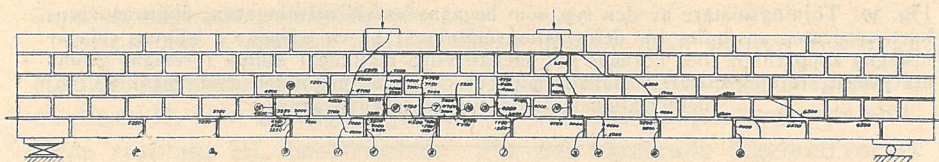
Sprickbildningsschema för balk 5, vilket utvisar den ordning, i vilken spric-
